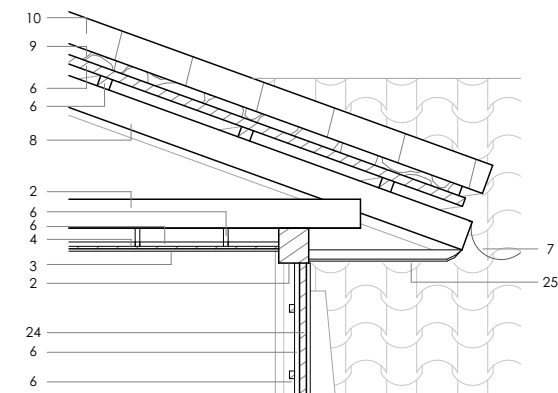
Detalle Constructivo 04. ESC 1:50
